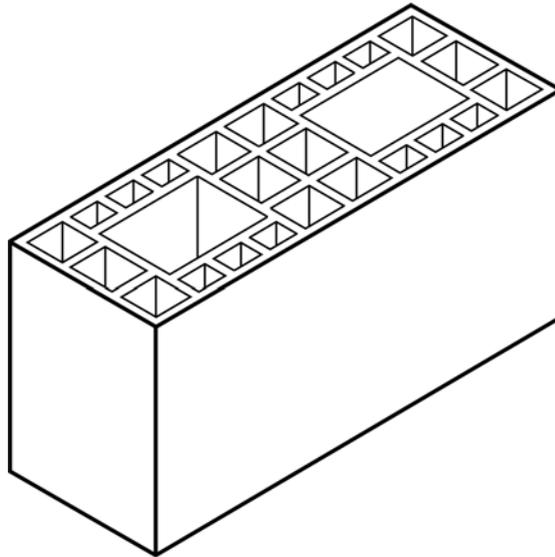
Bloco cerâmico estrutural de paredes vazadas
